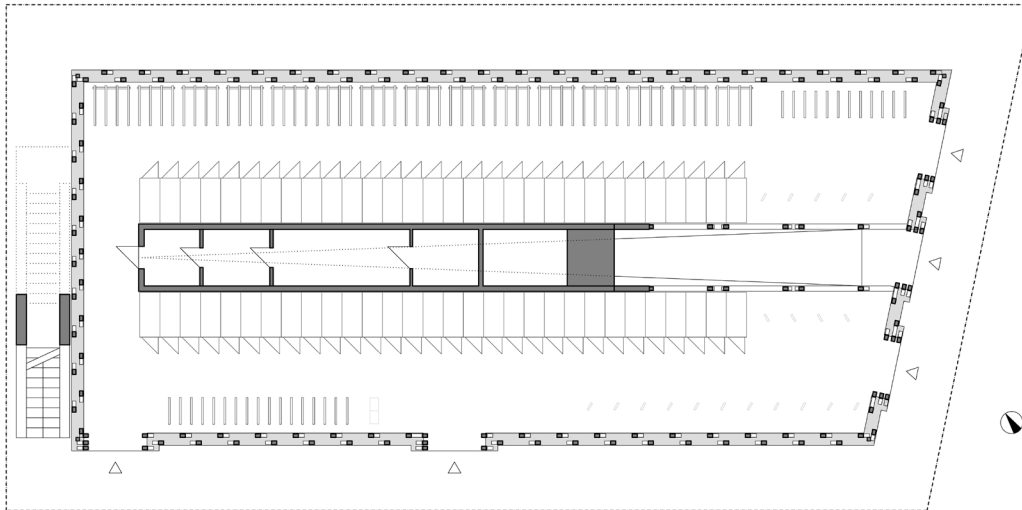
Grundriss EG (Leitplan GmbH)
